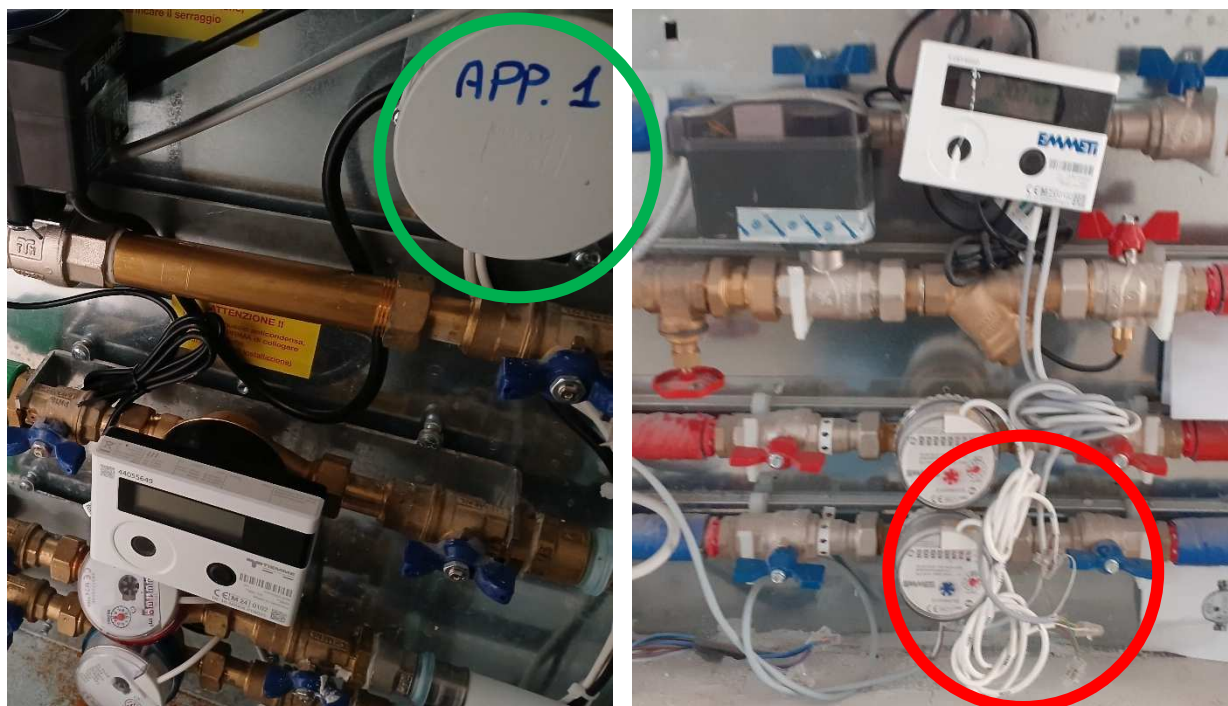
Protezione collegamenti e lettrici nella cassetta satellite: installazione corretta (sx) e installazione errata (dx)
